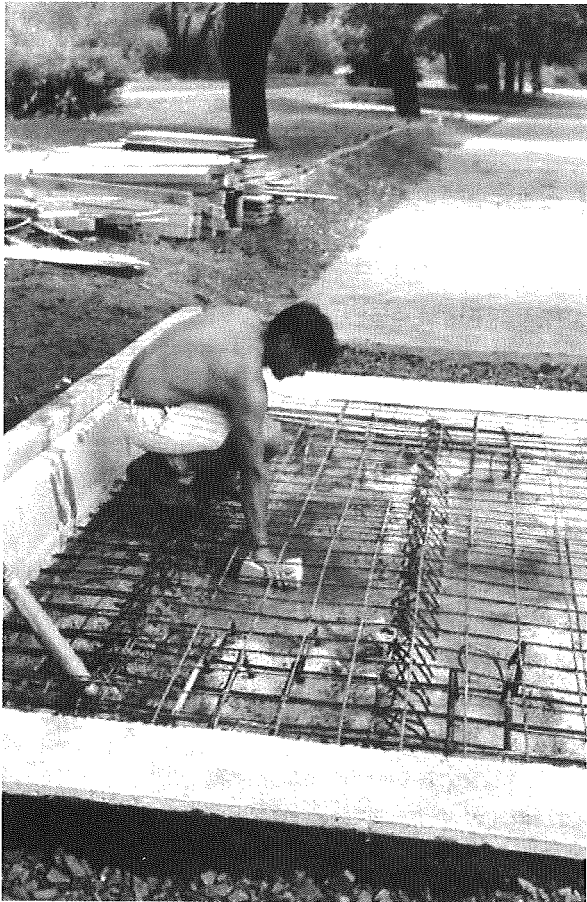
Reinigen und Trocknen der verlegten, regennassen Elementdeckenplatten vor dem Betonieren
